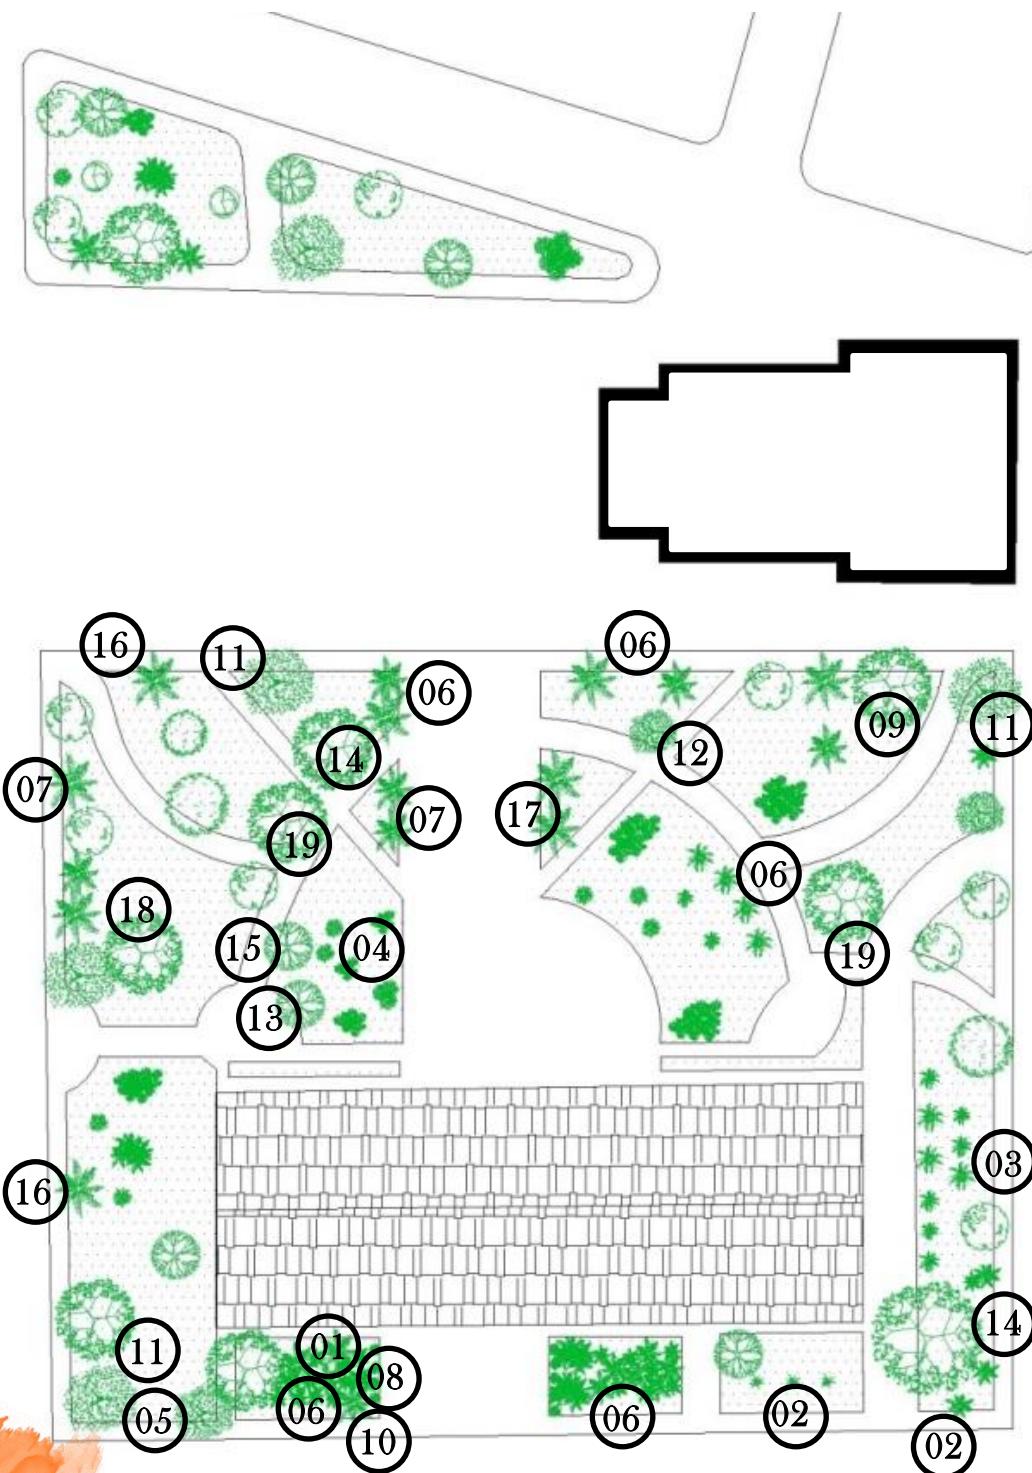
Planta baixa da Praça. Fonte: Elaborado pela autora
